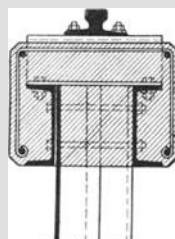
Kranholm aus Eisenbeton auf einer eisernen Spundwand (Larssen).
